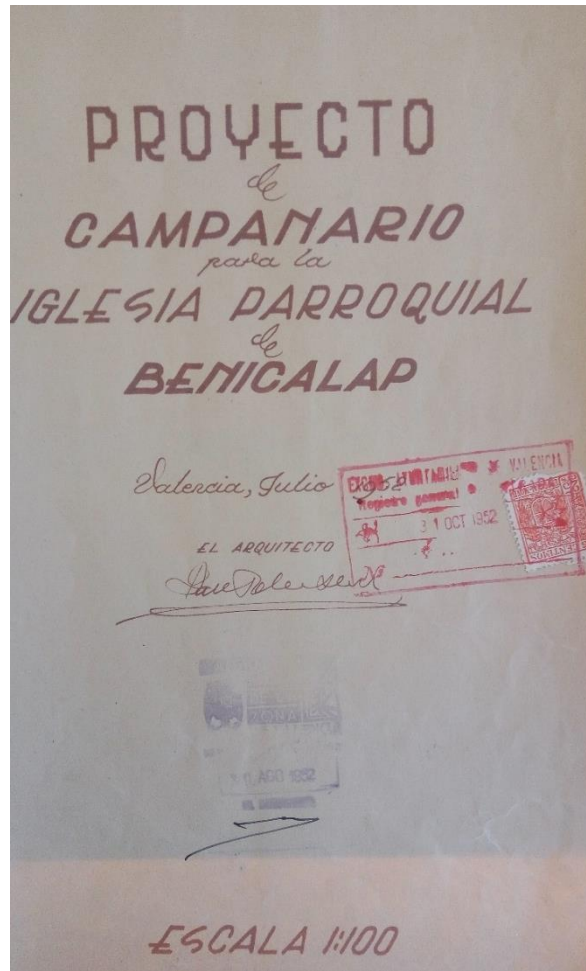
Proyecto original de la construcción de la torre campanario. Fuentes propias
